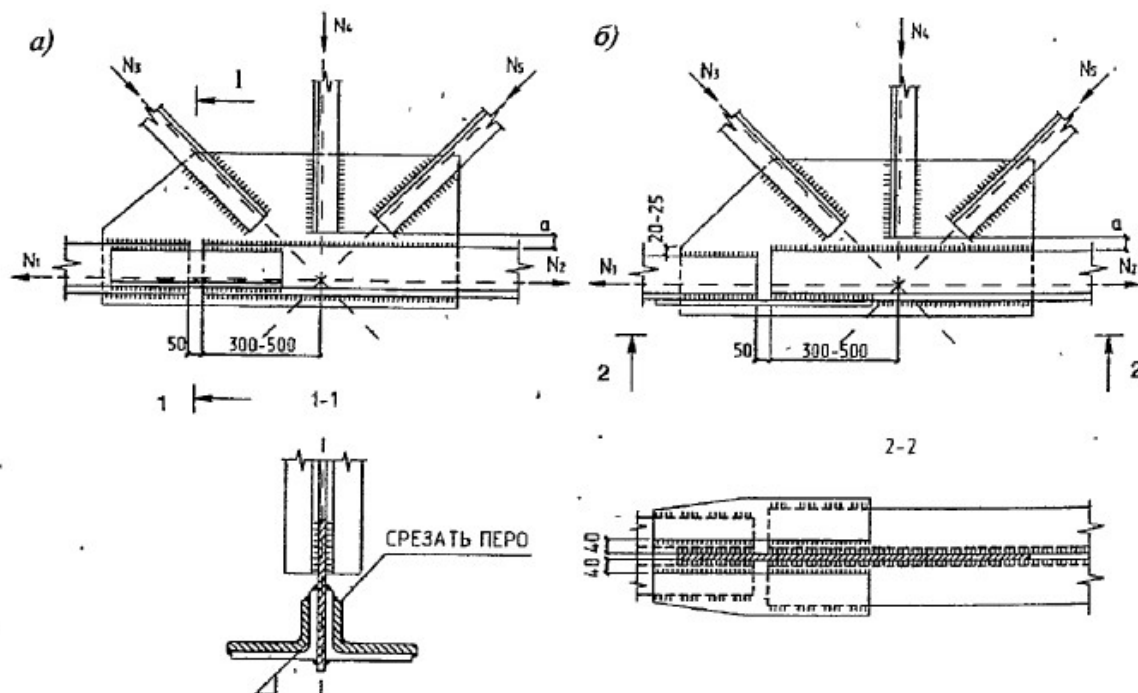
Узлы ферм с изменением сечения: а – с уголковыми накладками; б – с листовыми накладками.
